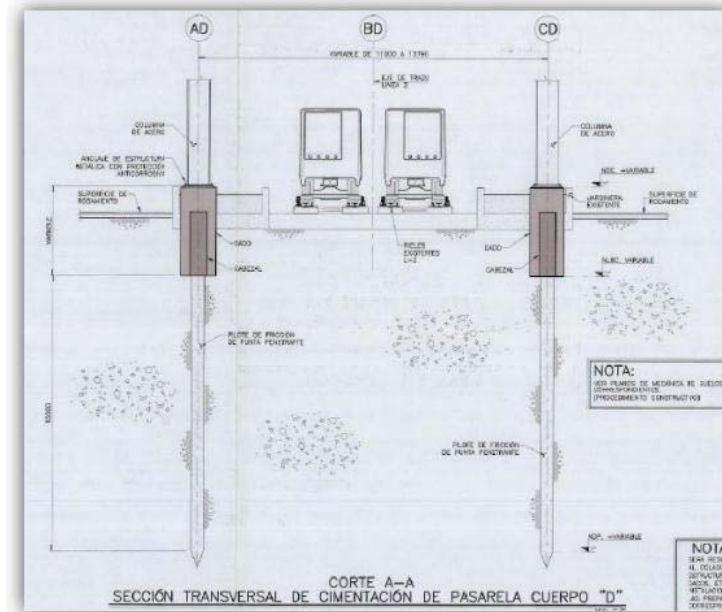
Sección transversal de cimentación de pasarela cuerpo "D"
